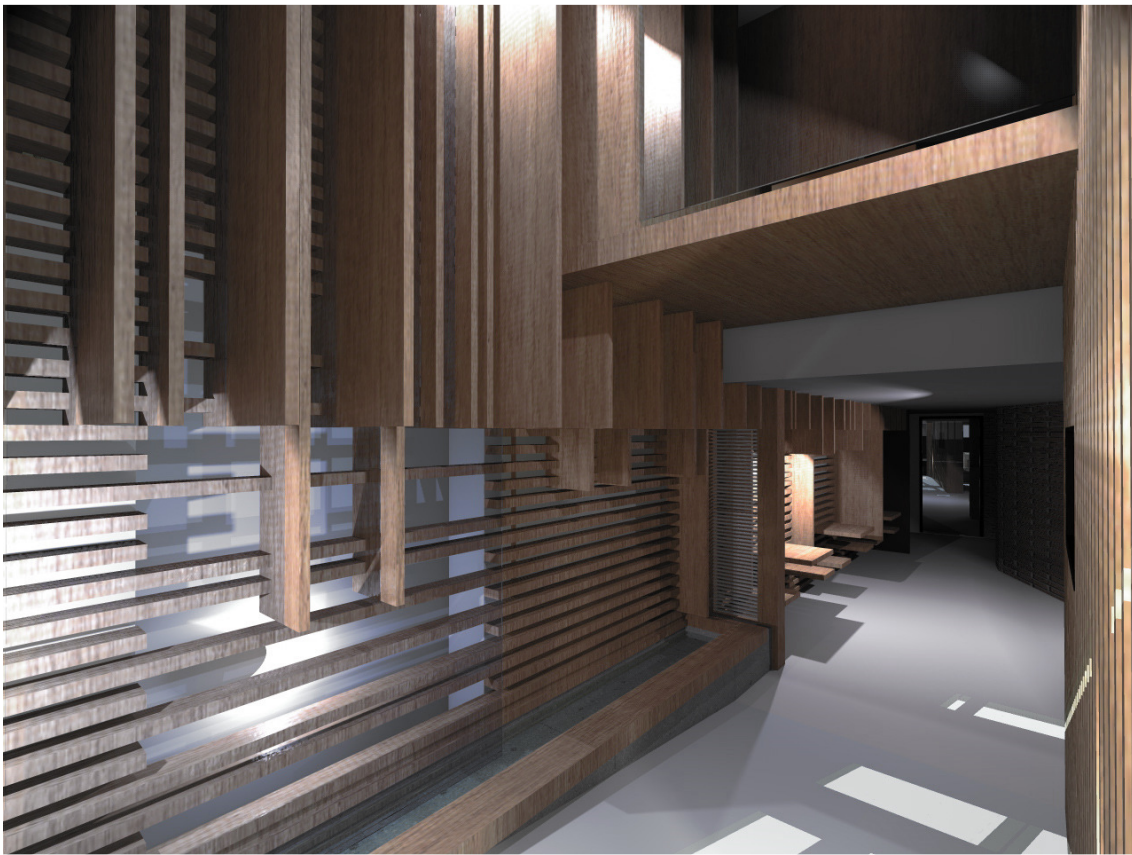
Lamas de madera en vestíbulo de restaurante, tras acceso. Planta baja.
